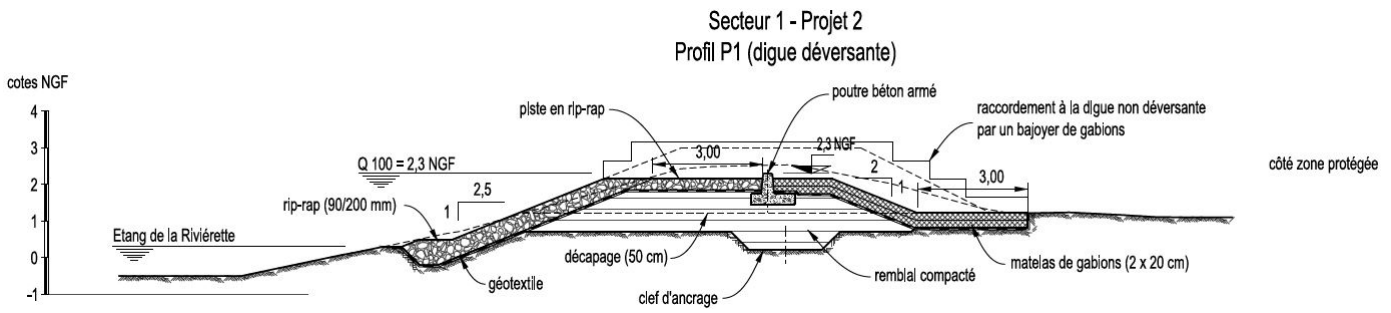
COUPE-TYPE D'UNE SECTION DEVERSANTE
